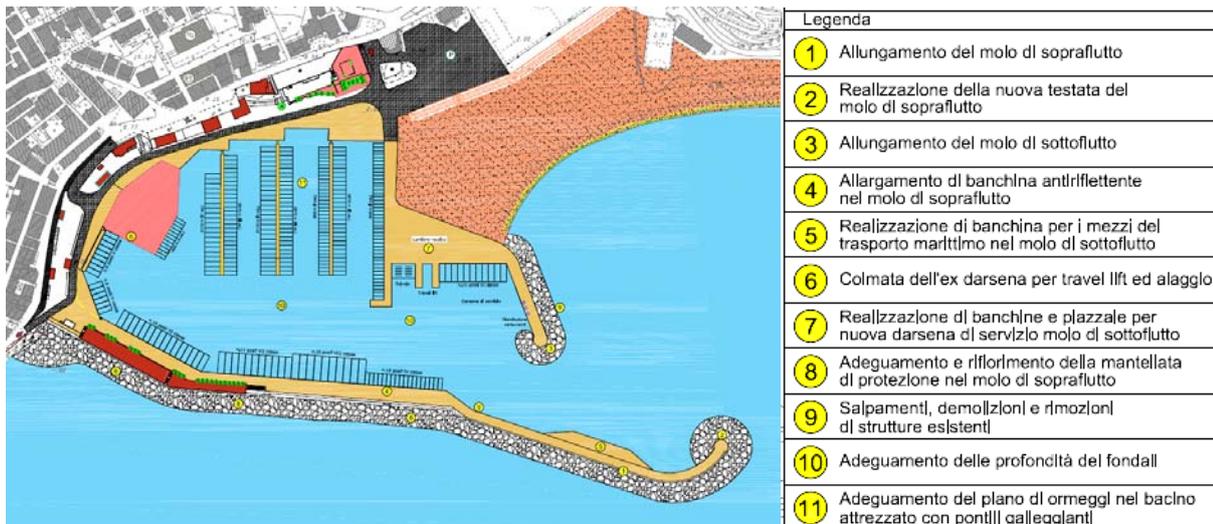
Planimetria del Progetto Generale previsto dal PUA in corso di approvazione
